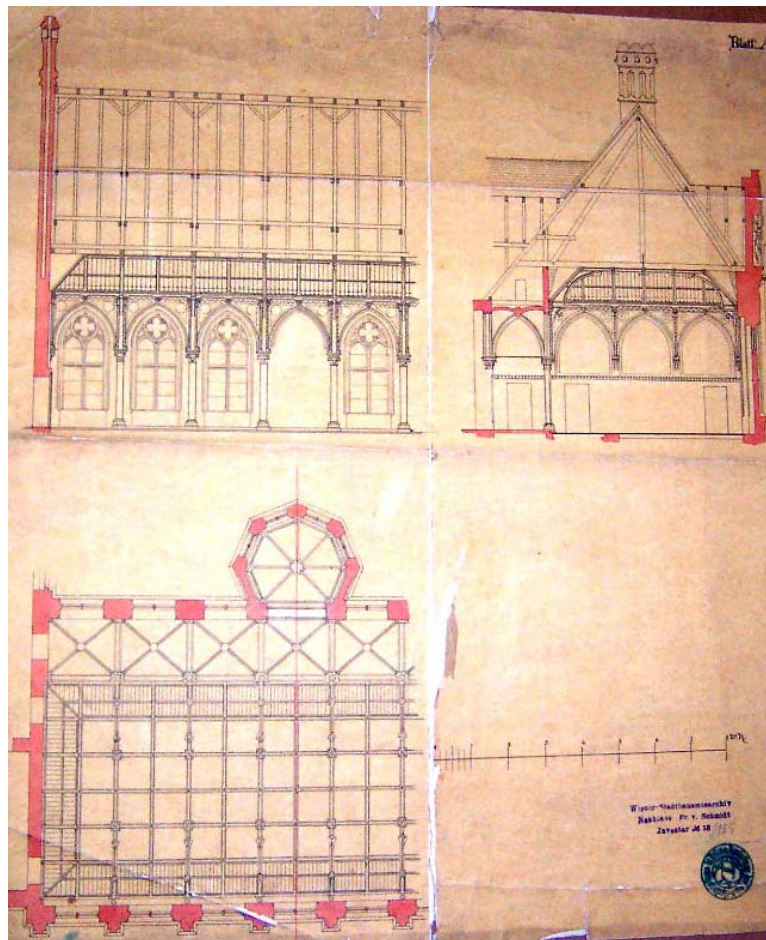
Grundriss, Quer- und Längsschnitt des zweiten Stockes
